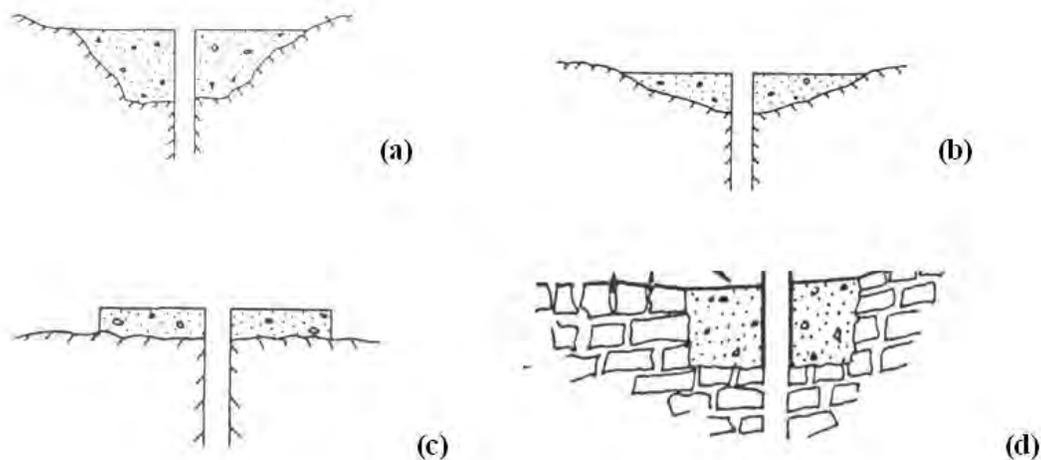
Figuras (a,b,c,d) llevan estructura de refuerzo de acero
